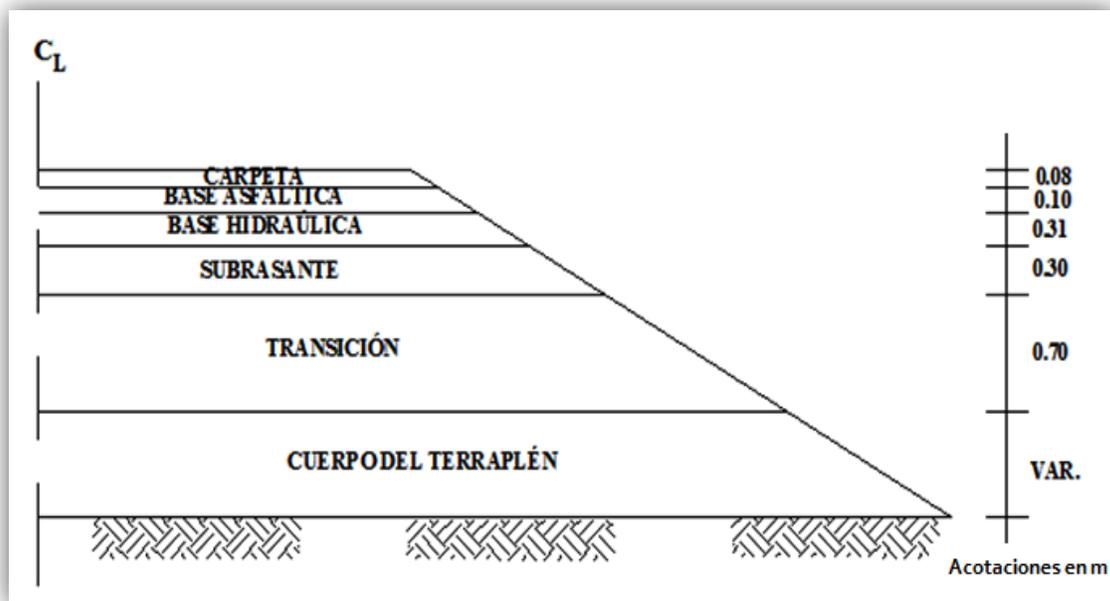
Espesores correspondientes a las diferentes capas que constituirán al camino proyectado
